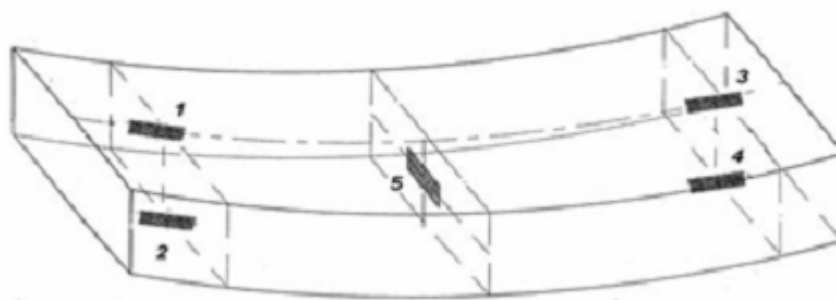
Schema di disposizione della strumentazione concio Linea 1 (Pepe, 2007).
